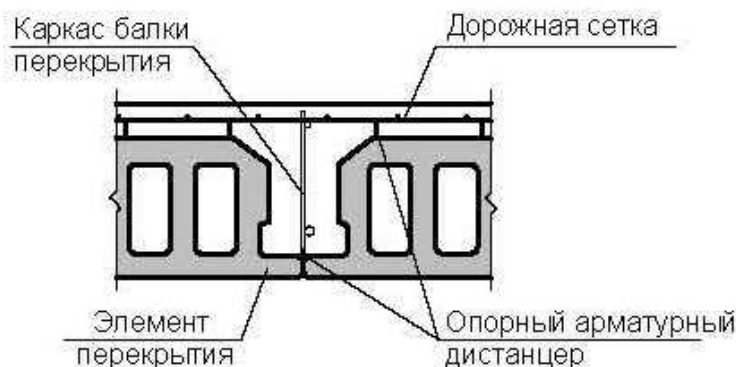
Размещение арматуры в конструкции перекрытия - арматура ребра между элементами
